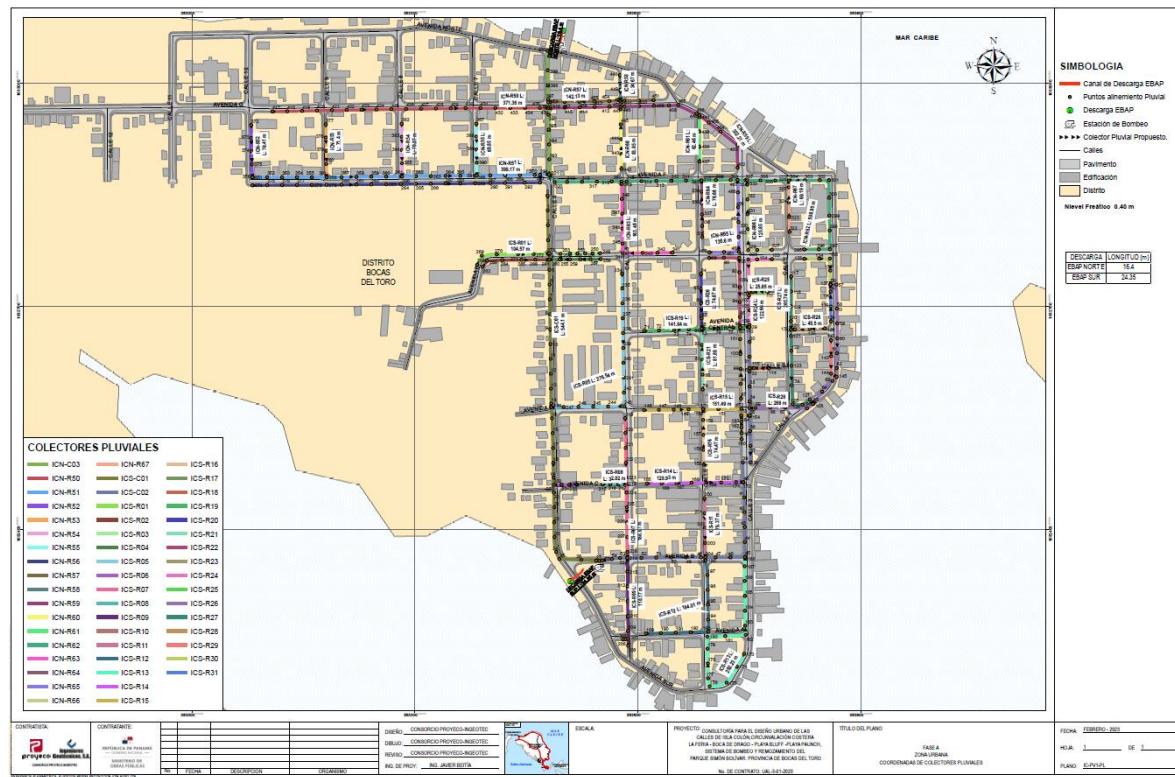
Plano de sistema pluvial hasta EBAPs (Anexo 12)
